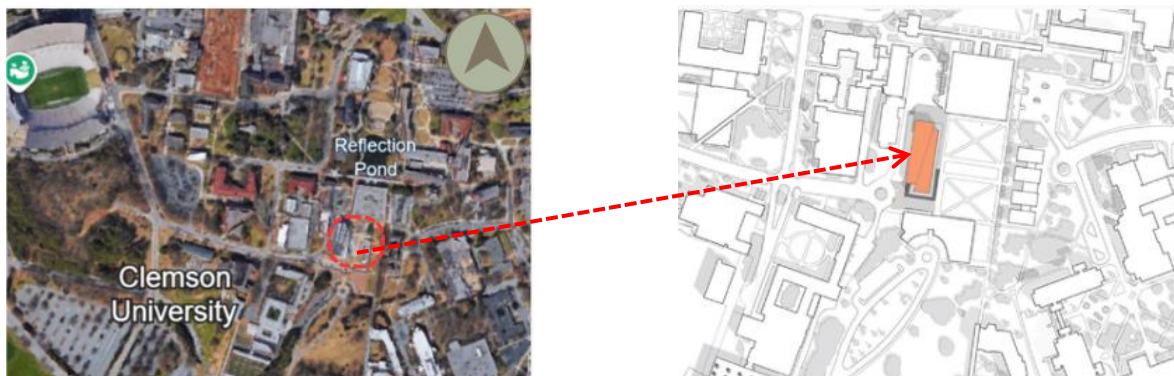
Plan de situation (Source: Perkins & Will ,Archidaily, 2016)
